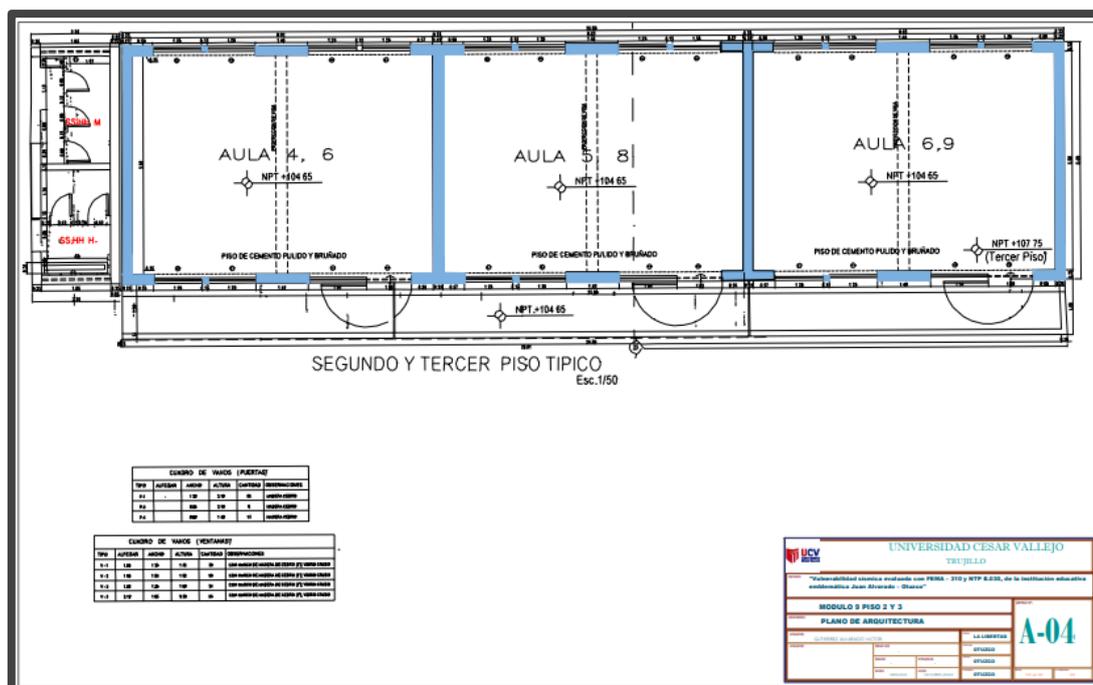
Plano arquitectónico módulo 2, segundo y tercer piso
